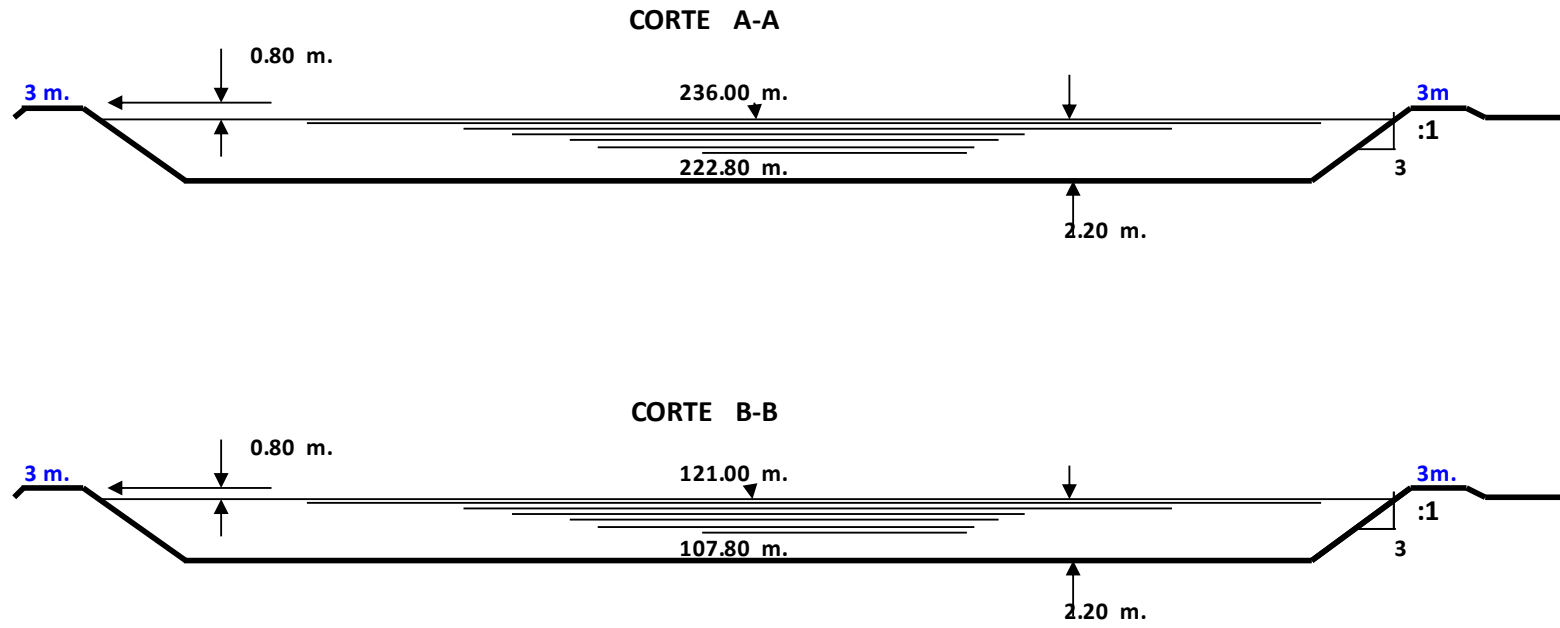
Dimensiones laguna primaria – Detalle en Corte
